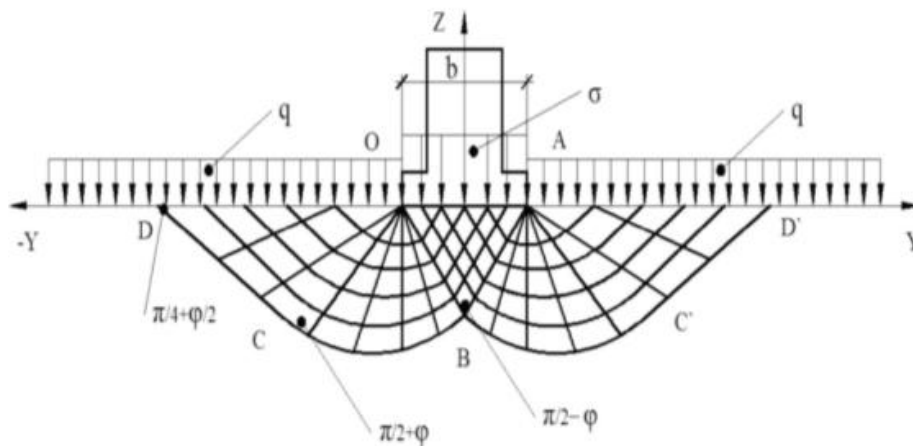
Розрахункова схема до визначення граничної несучої здатності основи фундаменту при тривалому навантаженні
